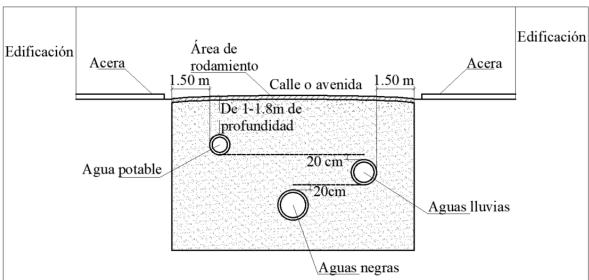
Distancias de tuberías de acueducto y alcantarillado.
